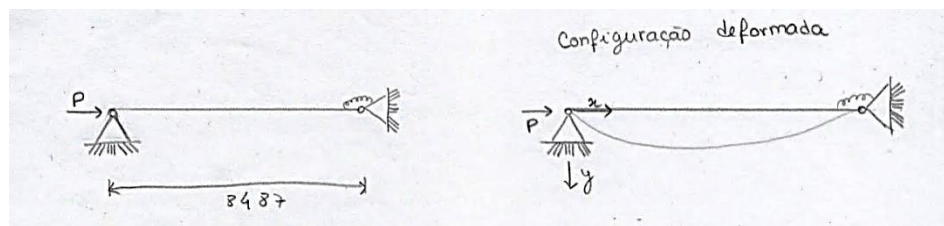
Modelo estrutural para determinação do comprimento de encurvadura da viga fora do plano de estrutura (plano x – y)
